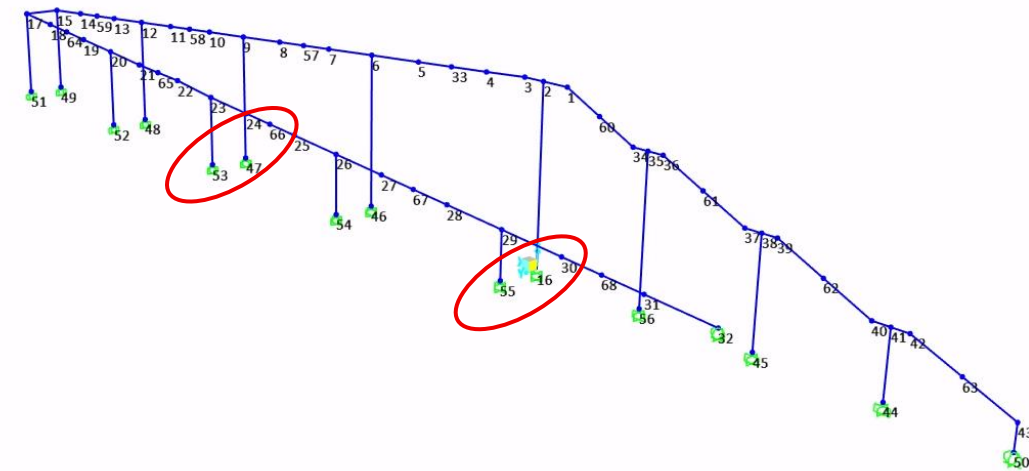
Notación de los nodos del modelo de SAP2000; en rojo se resaltan las pilas para las que se realizará el cálculo de detalle de las cimentaciones. Fuente: Elaboración propia.
